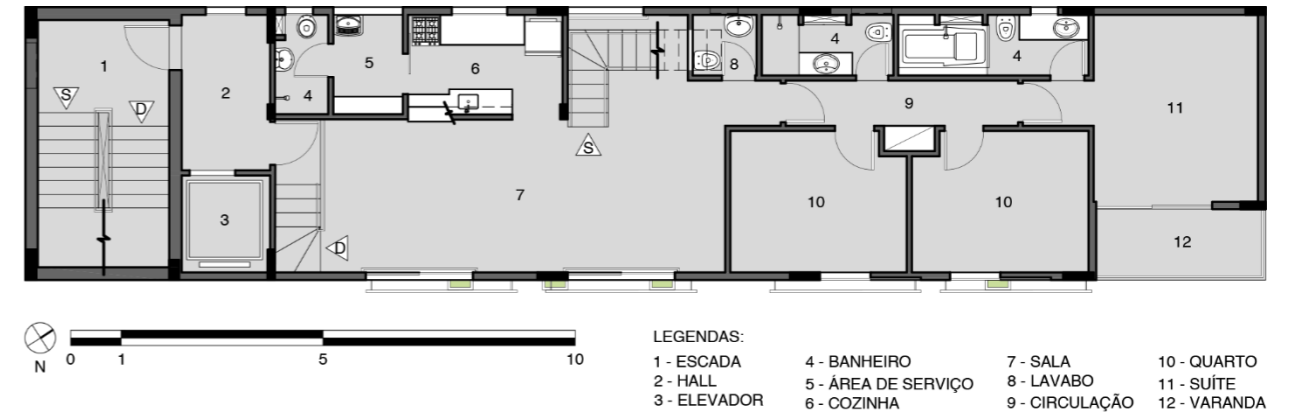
Planta do oitavo pavimento do Montevidéu 285
